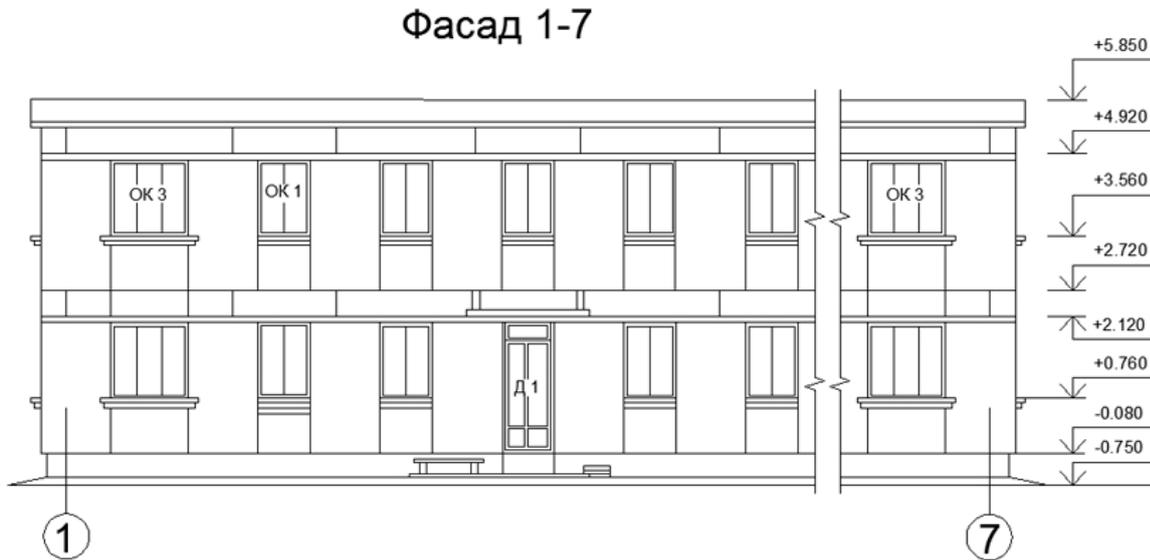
Фасад 1-7 крупноблочного жилого дома
